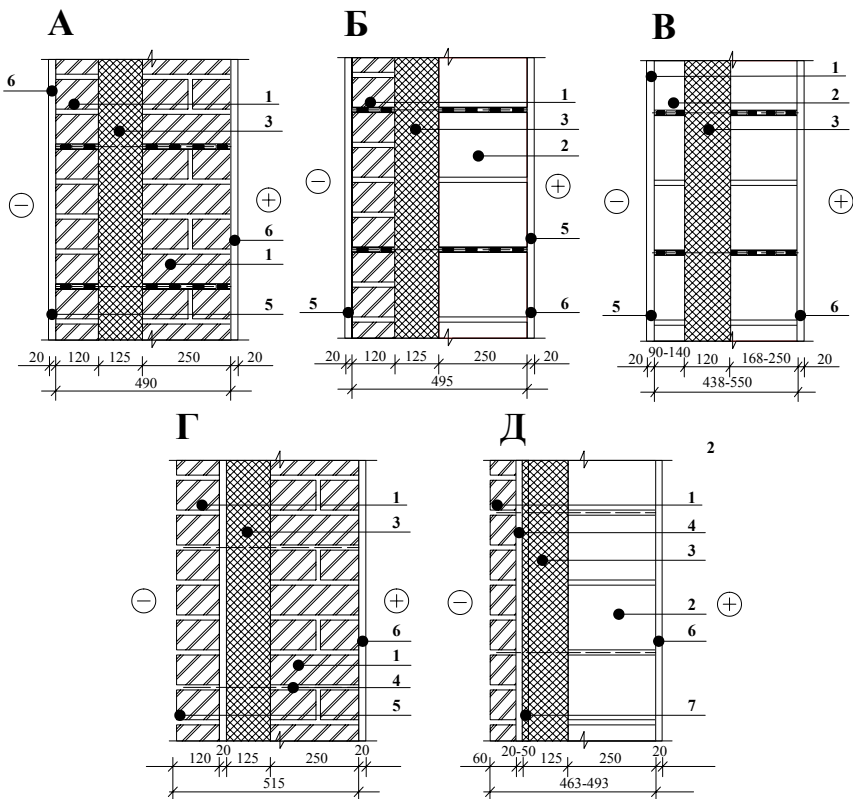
Конструктивные схемы трехслойных стен (PAROC):
